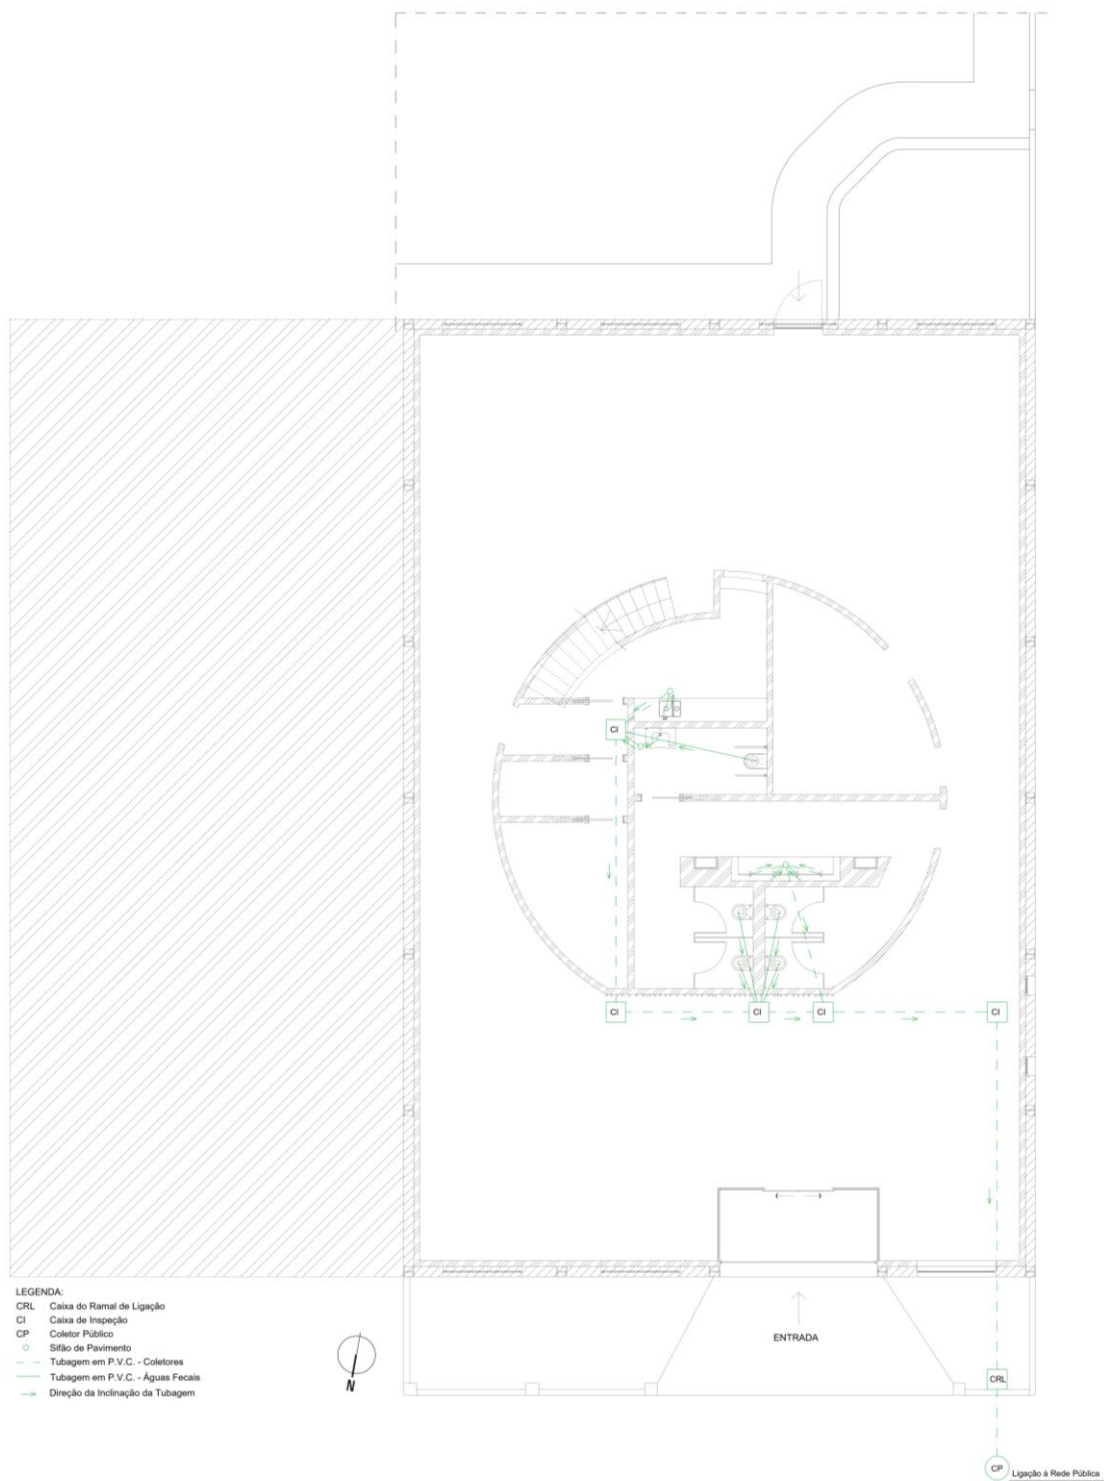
Desenho Técnico - Planta de Esgotos. Fonte: (Autor)
